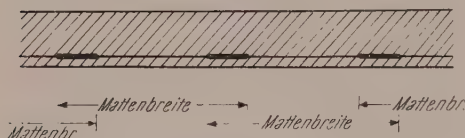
Stahlbetonplatte mit Mattenbewehrung
